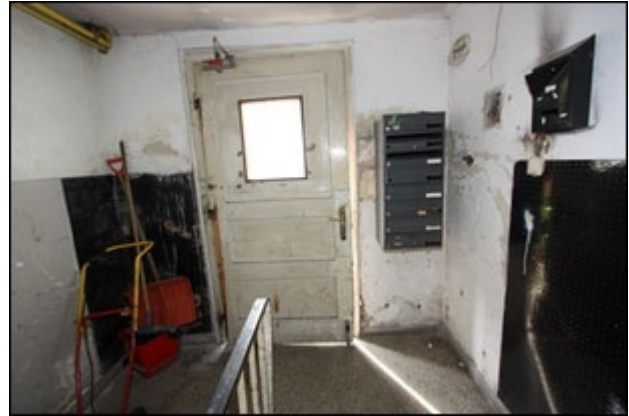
Ansicht Stiegenhaus EG, Hauseingang
